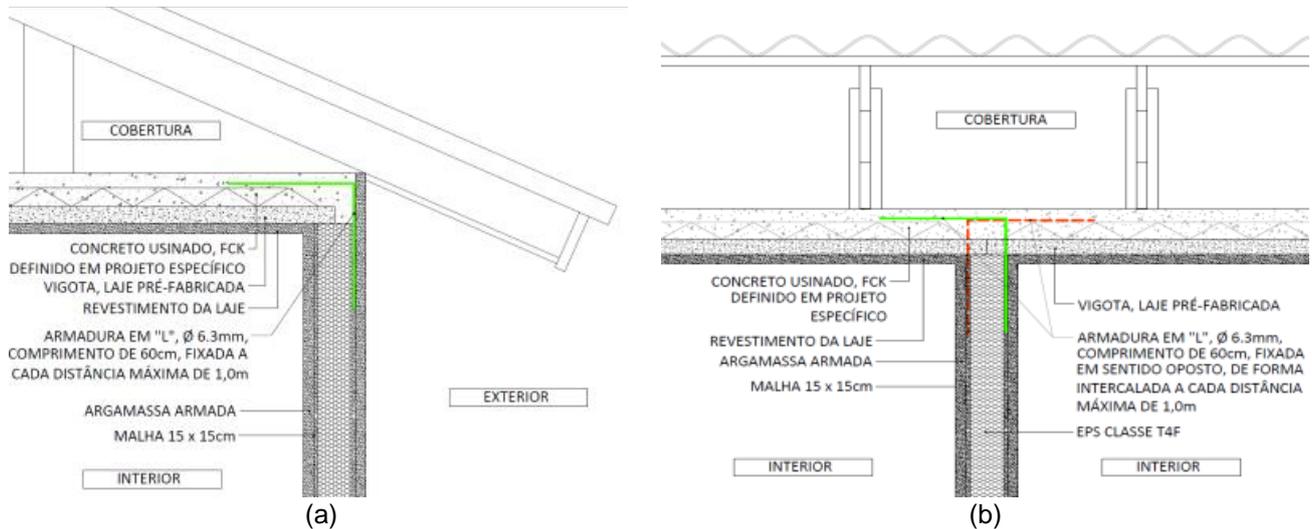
Detalhe ligação entre painel e laje pré-fabricada ou pré-moldada (a) paredes externas e (b) paredes internas
